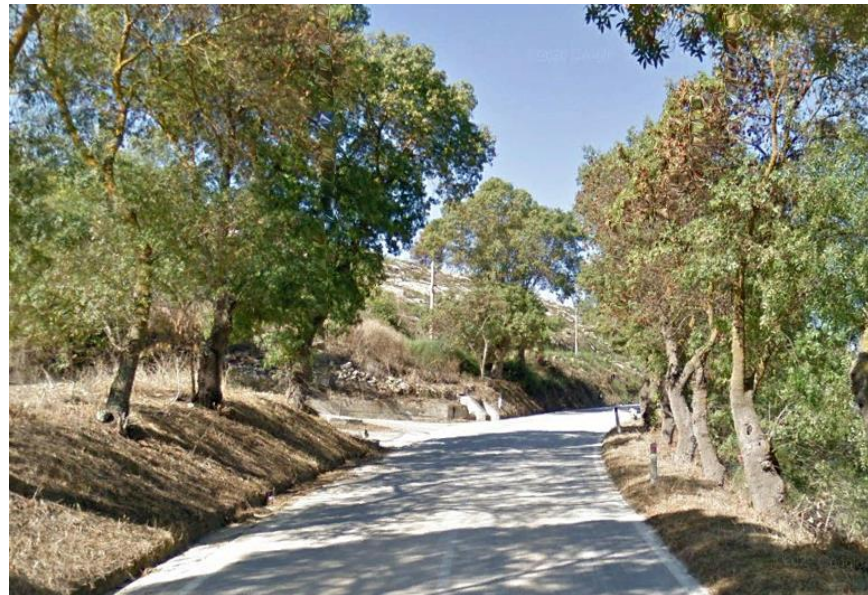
Tratto della SS188 interessato dall'attraversamento del cavidotto
